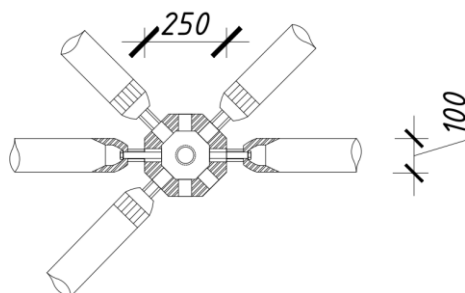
Узел крепления трубчатых стержней к коннектору (Чертеж автора).
